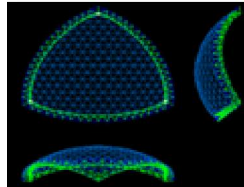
poutre tridimensionnelle. Source : archistruktures.org
